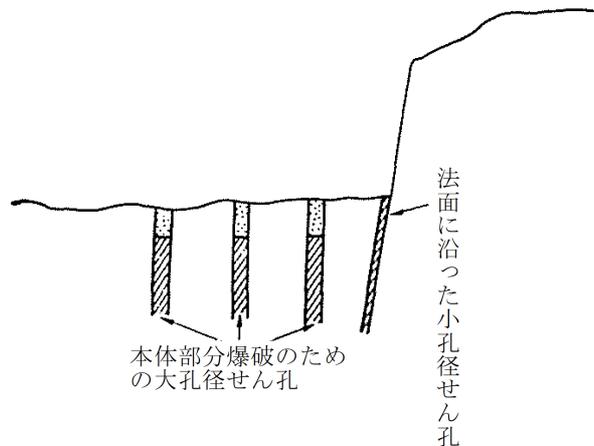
法面仕上げを同時に行う爆破法³⁾
